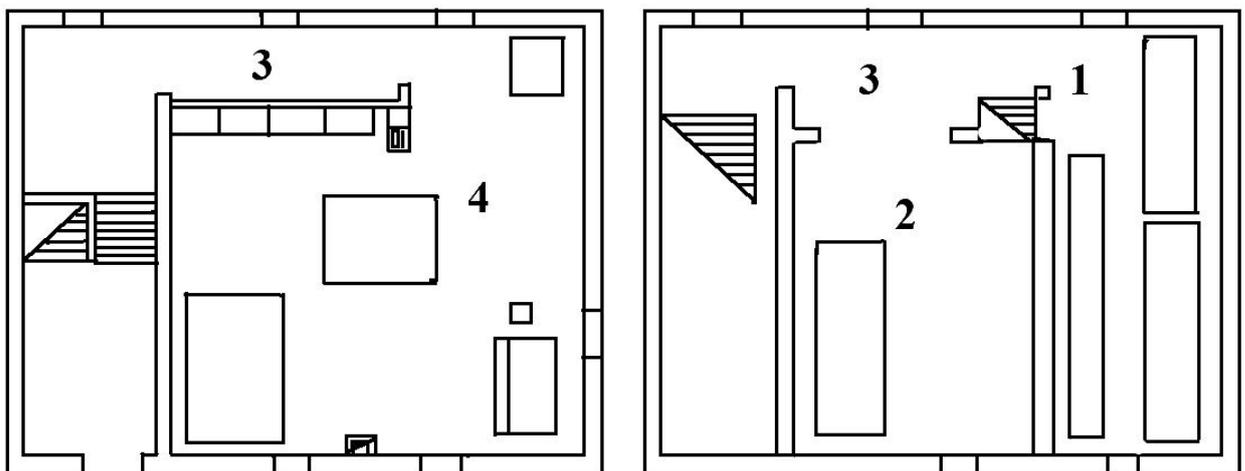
План типового склада 411-1-52 для хранения до 2,5 т семян с помещением для стратификации: А - план на отметке 0,000; Б - план на отметке $-2,870$ м; 1 - отделение стратификации семян; 2 - отделение хранения тары; 3 - тамбуры; 4 - отделение обработки и хранения семян
